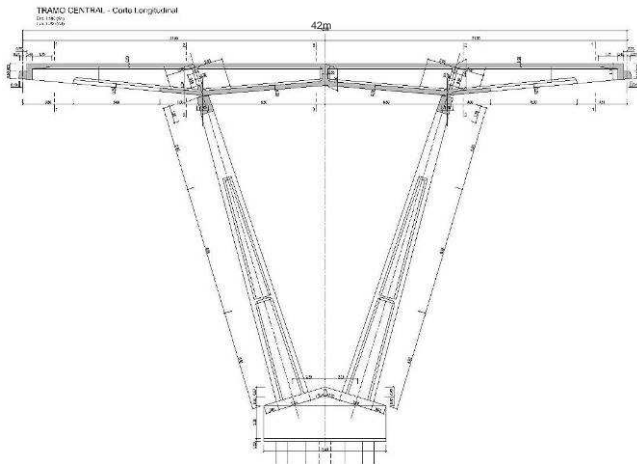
Pilar de Rio: corte longitudinal pelo tramo central
